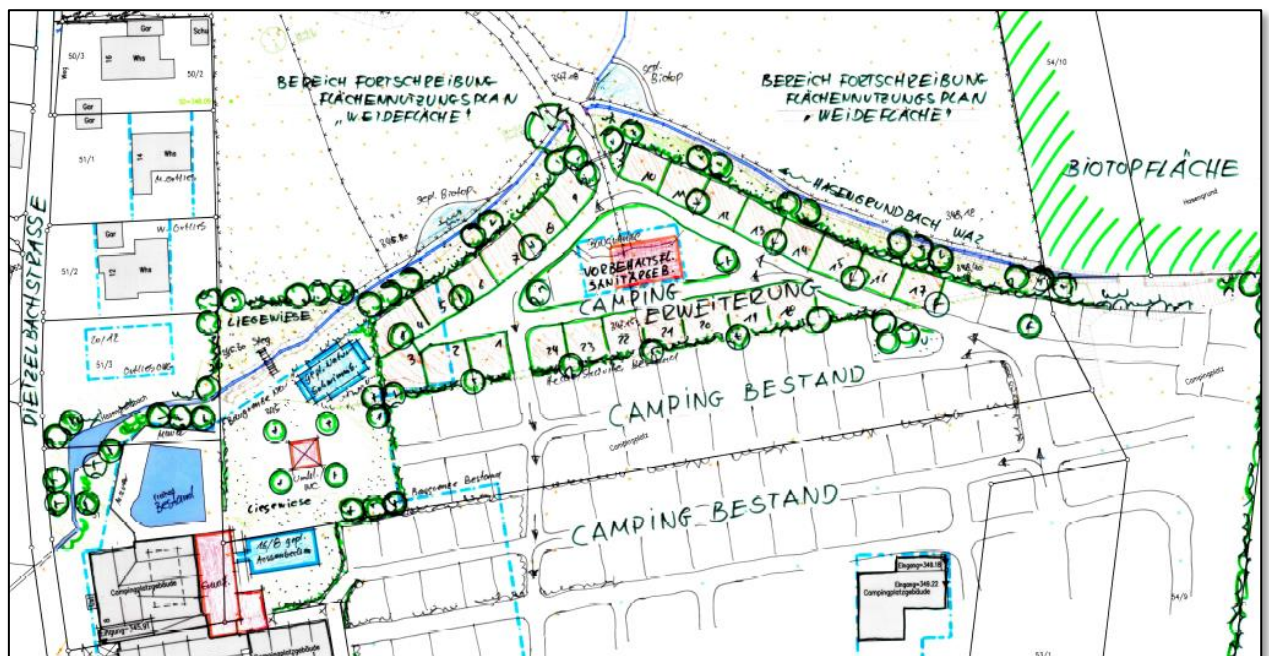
Bebauungsentwurf (Gestaltungsplan) zur 3. Änderung des Bebauungsplans (KAMENISCH Stand 11.04.2024)
